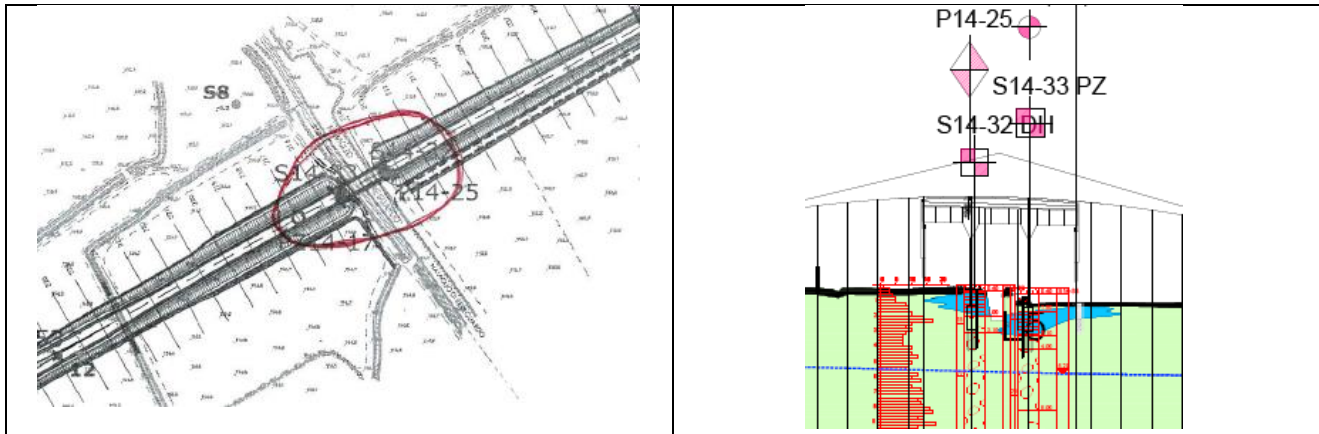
Stralcio planimetrico e stralcio profilo geologico Ponte Naviglio Bereguardo
